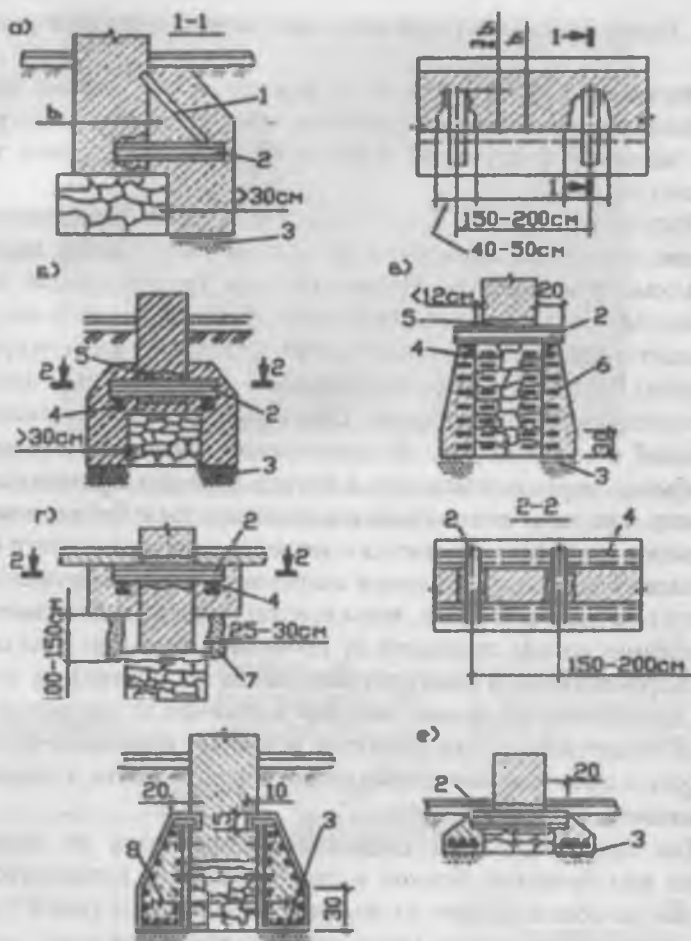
Усиление существующих ленточных фундаментов монолитными балками:
